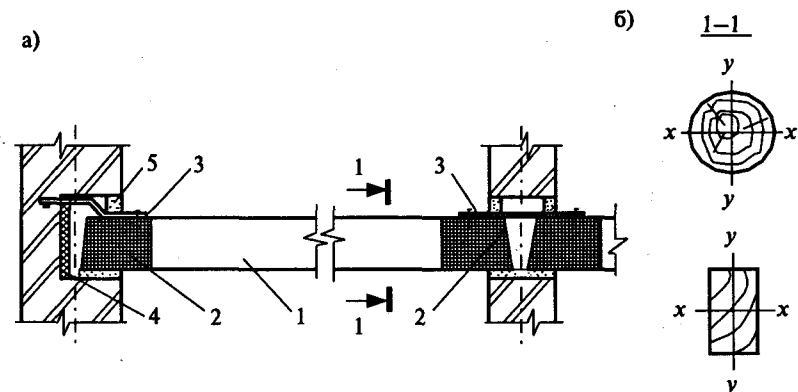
Вариант опирания деревянной балки на кирпичные стены: а) балка из цельной древесины; б) сечения балок из цельной древесины; 1 — балка; 2 — два слоя толя; 3 — анкер из полосовой стали; 4 — теплоизоляция; 5 — цементно-песчаный раствор
